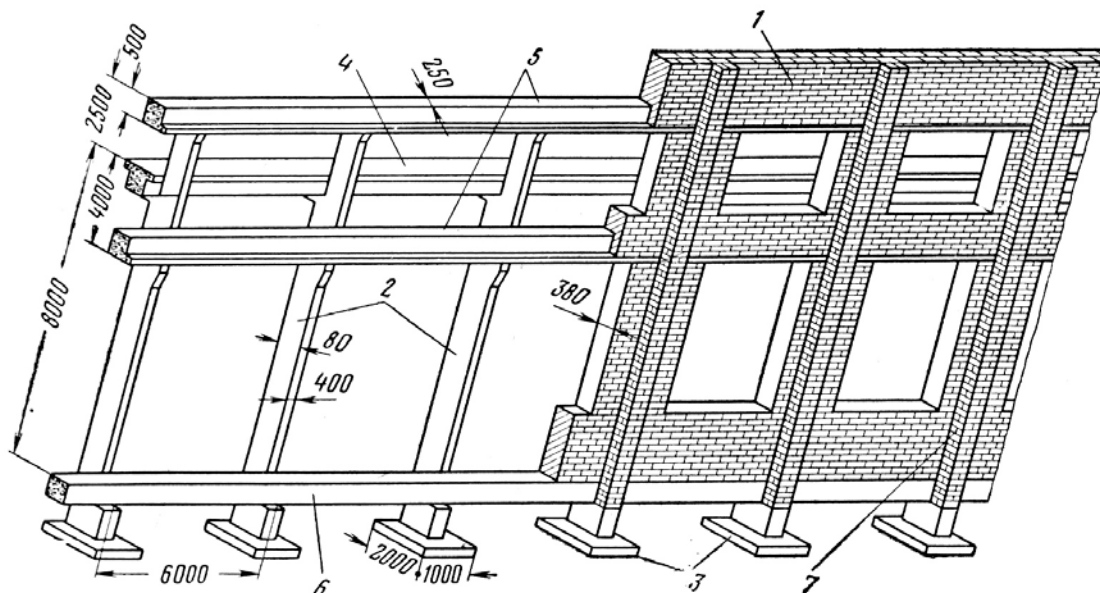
Конструкция каркасной стены здания с железобетонным каркасом:
